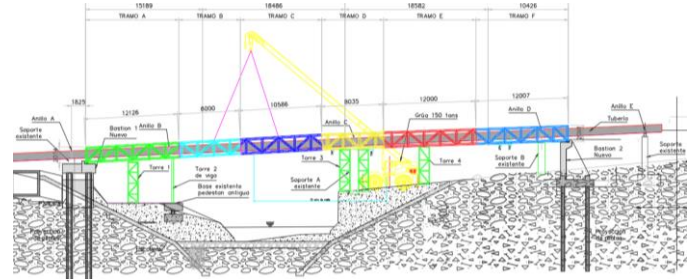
Esquema de montaje de estructura metálica. *Plan de construcción MECO y STEEL.
